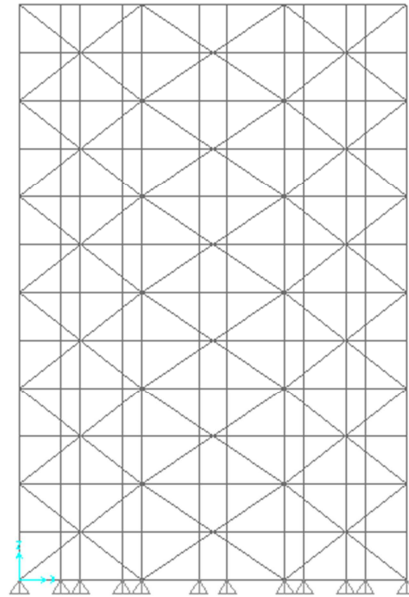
Configuração dos Planos de Contraventamento Vertical Com Elementos de Contraventamento Grandes
